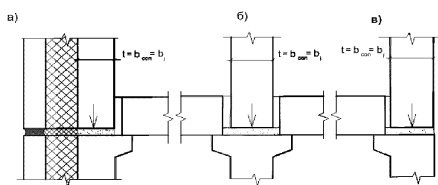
Контактный стык: а – наружная стеновая панель; б – внутренние стеновые панели двухсторонний стык; в – внутренние стены односторонний стык
